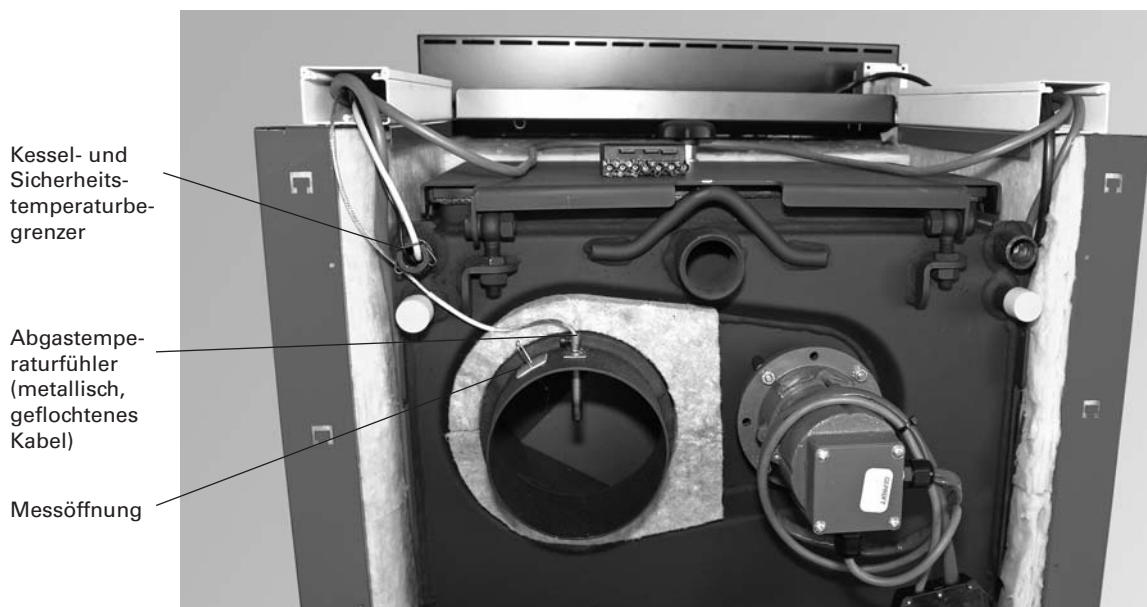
Isolierung Abgasstutzen anbringen; Kessel- und STB-Fühler in Tauchhülse stecken und mit Fühlersicherung sichern; Abgastemperaturfühler in Abgasstutzen stecken und mit Schraube sichern
